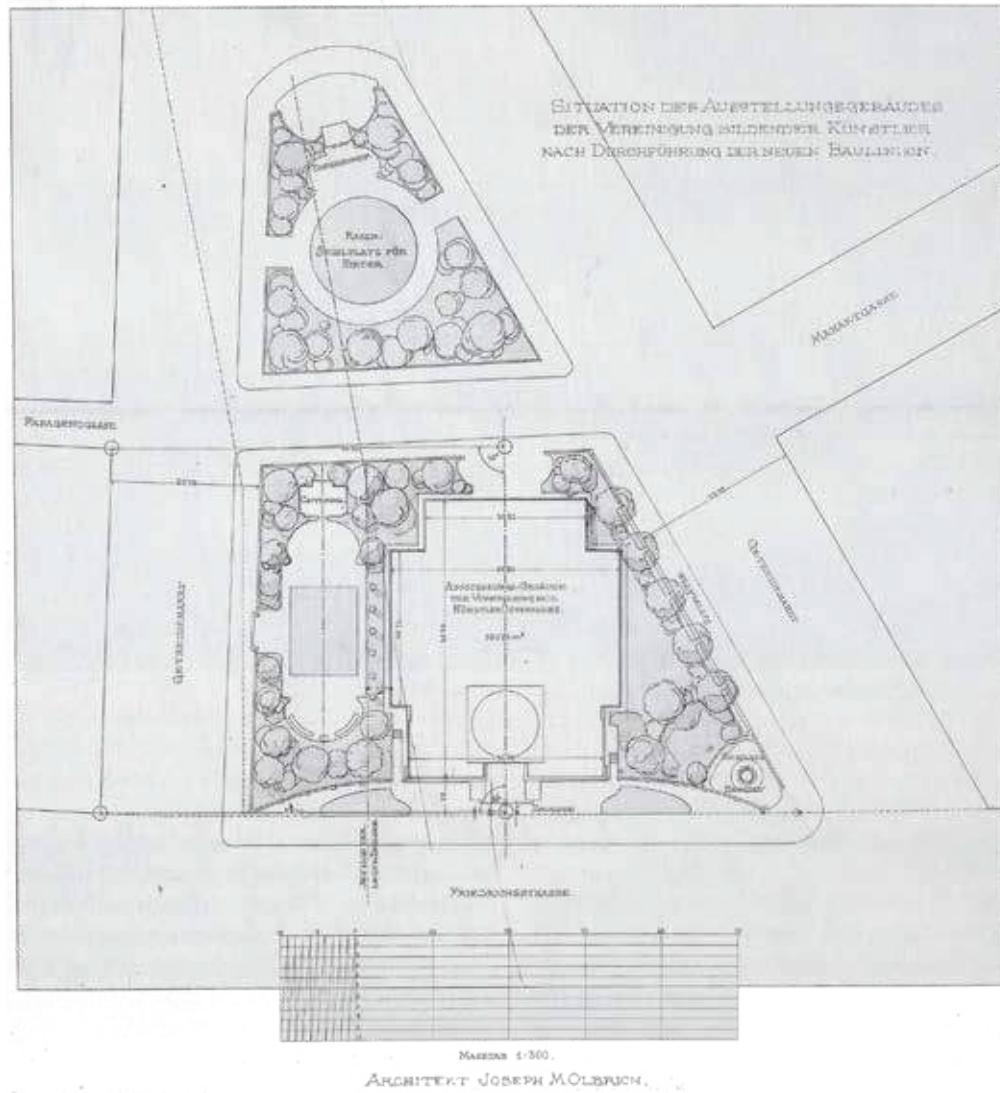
Lageplan des Zweiten Entwurfs 1897
